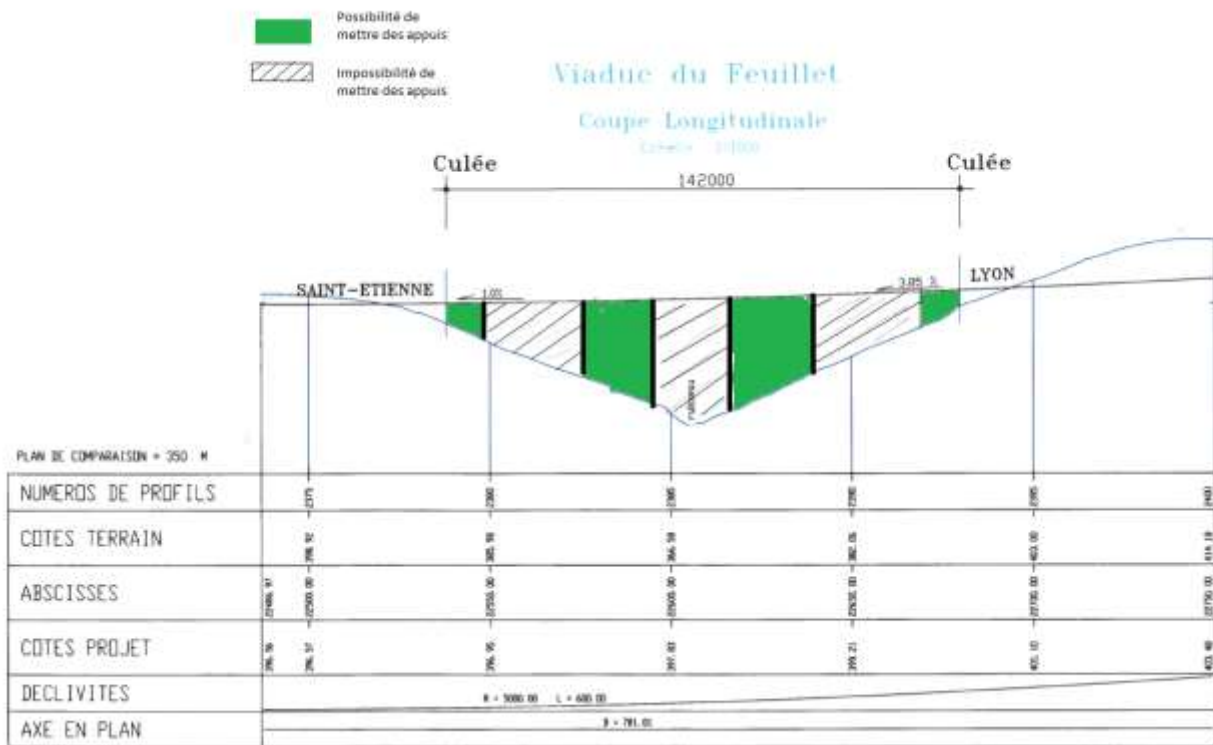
COUPE LONGITUDINALE MONTRANT LES CONTRAINTES SUR LES ZONES D'IMPLANTATION DES PILES
